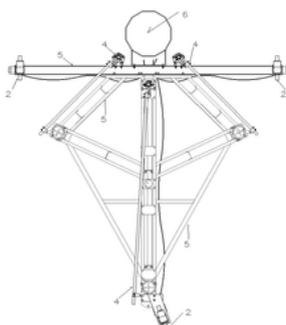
Vista en planta de un sistema de seccionamiento de 3 vías: 2. Sensor corriente/voltaje, 4. Mecanismos de operación, 5. Estructura soporte de equipo, 6. Poste de acero como estructura de montaje del seccionamiento.
